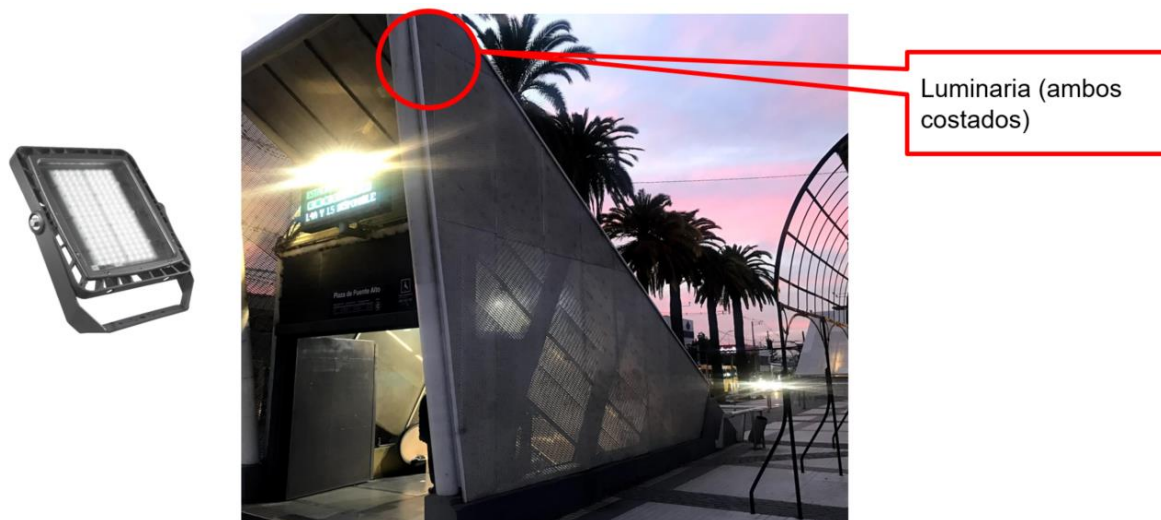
Vista lateral Accesos Norte y Sur – Tipo
